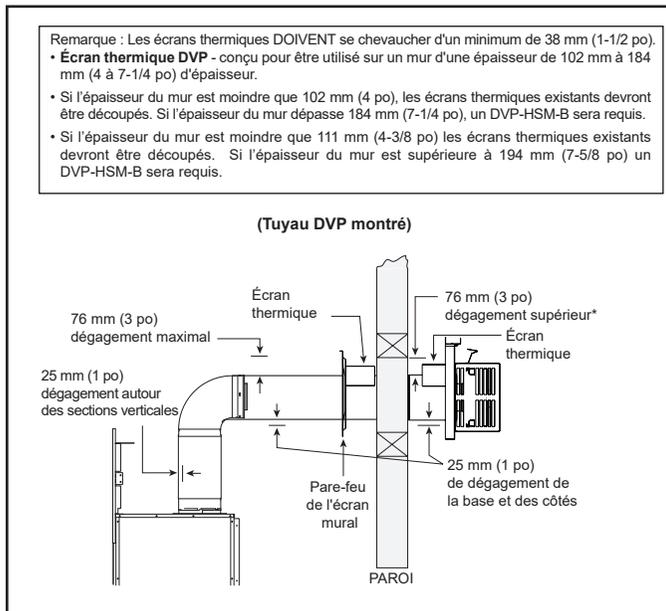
Dégagements des conduits horizontaux avec les matériaux inflammables
